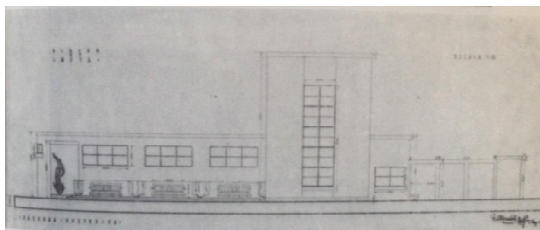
Planimetría original del alzado principal del Rincón de Goya, García Mercadal, Zaragoza (1927).
